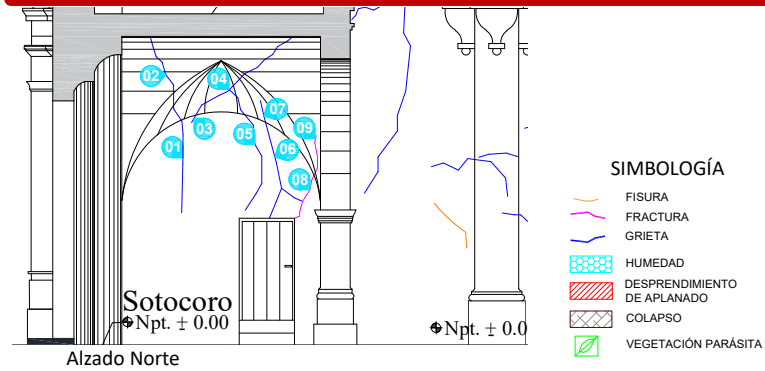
Detalle de afectaciones en intradós de cubierta y muro adyacente parte poniente
